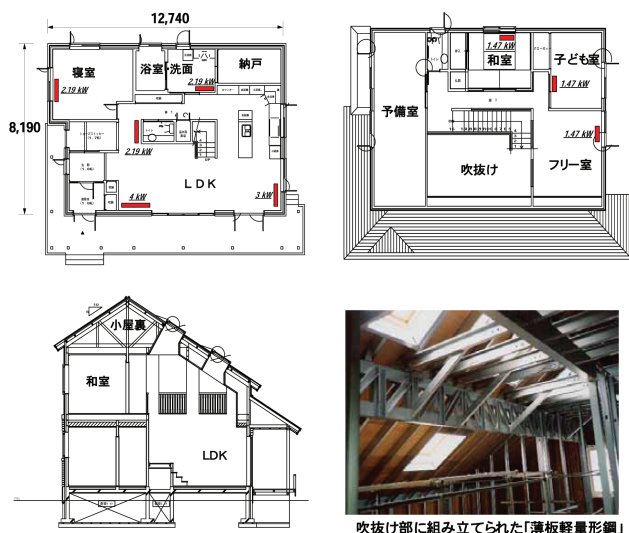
遠軽仕様の概要(1階[上段左], 2階平面図[上段右], 断面図[下段左], 建設中の住宅内観写真[下段右])
